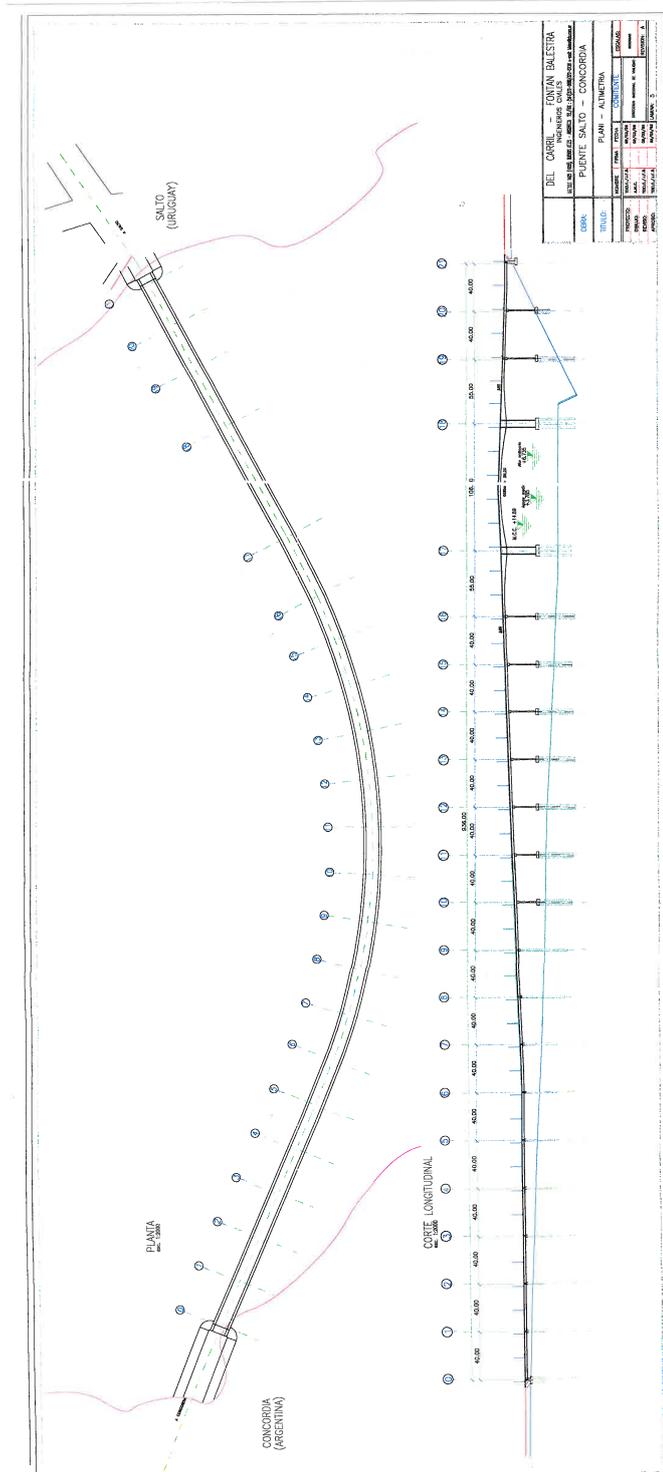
Planta y Vista longitudinal del trazado estudiado (Proyecto del Consorcio SALCON).
